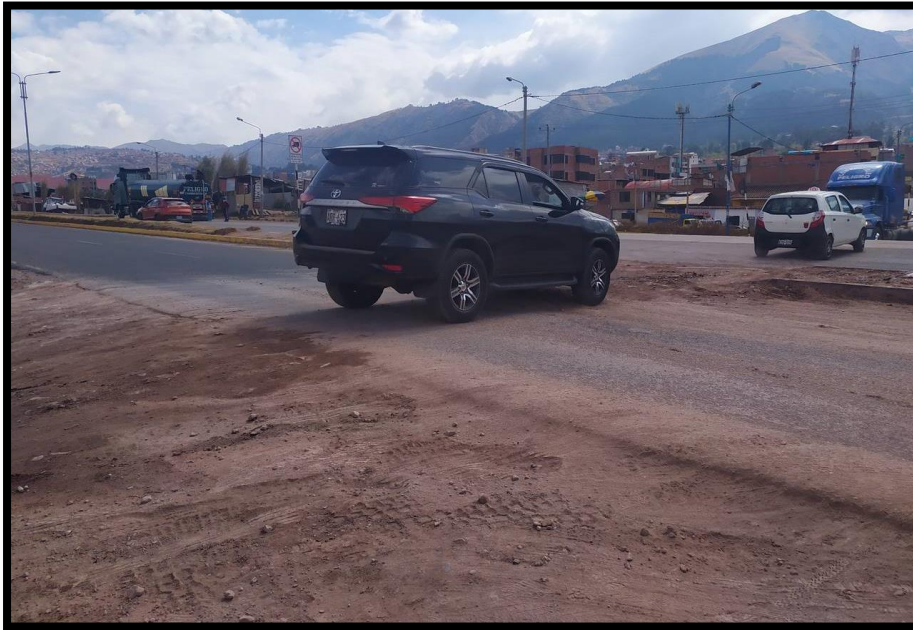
Paso transversal informal de autos paradero Santa Elena Avenida Evitamiento
